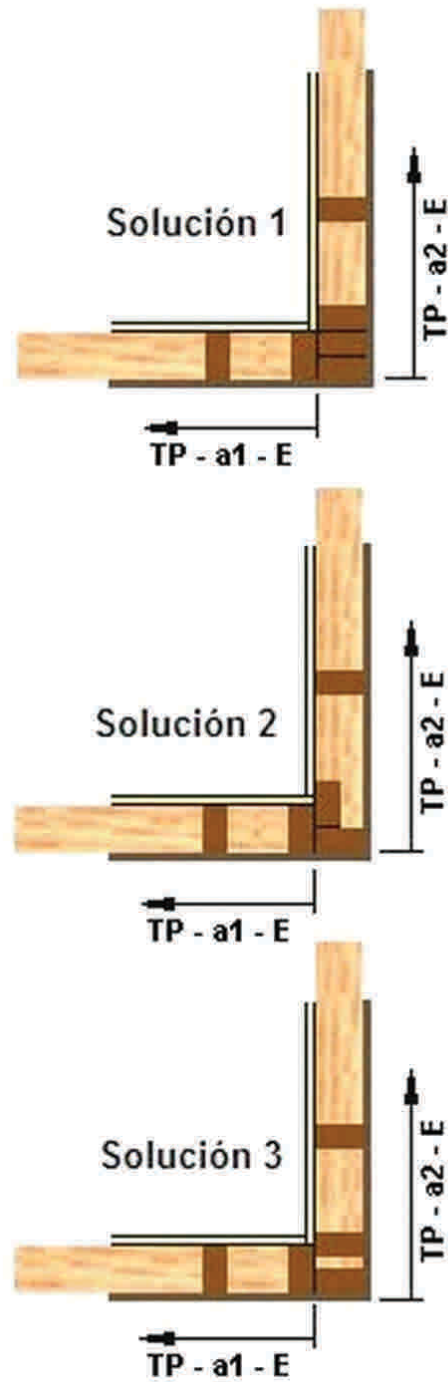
57: Vista en planta de soluciones 1,2 y 3 para el encuentro de muros y / o tabiques en ángulo.
